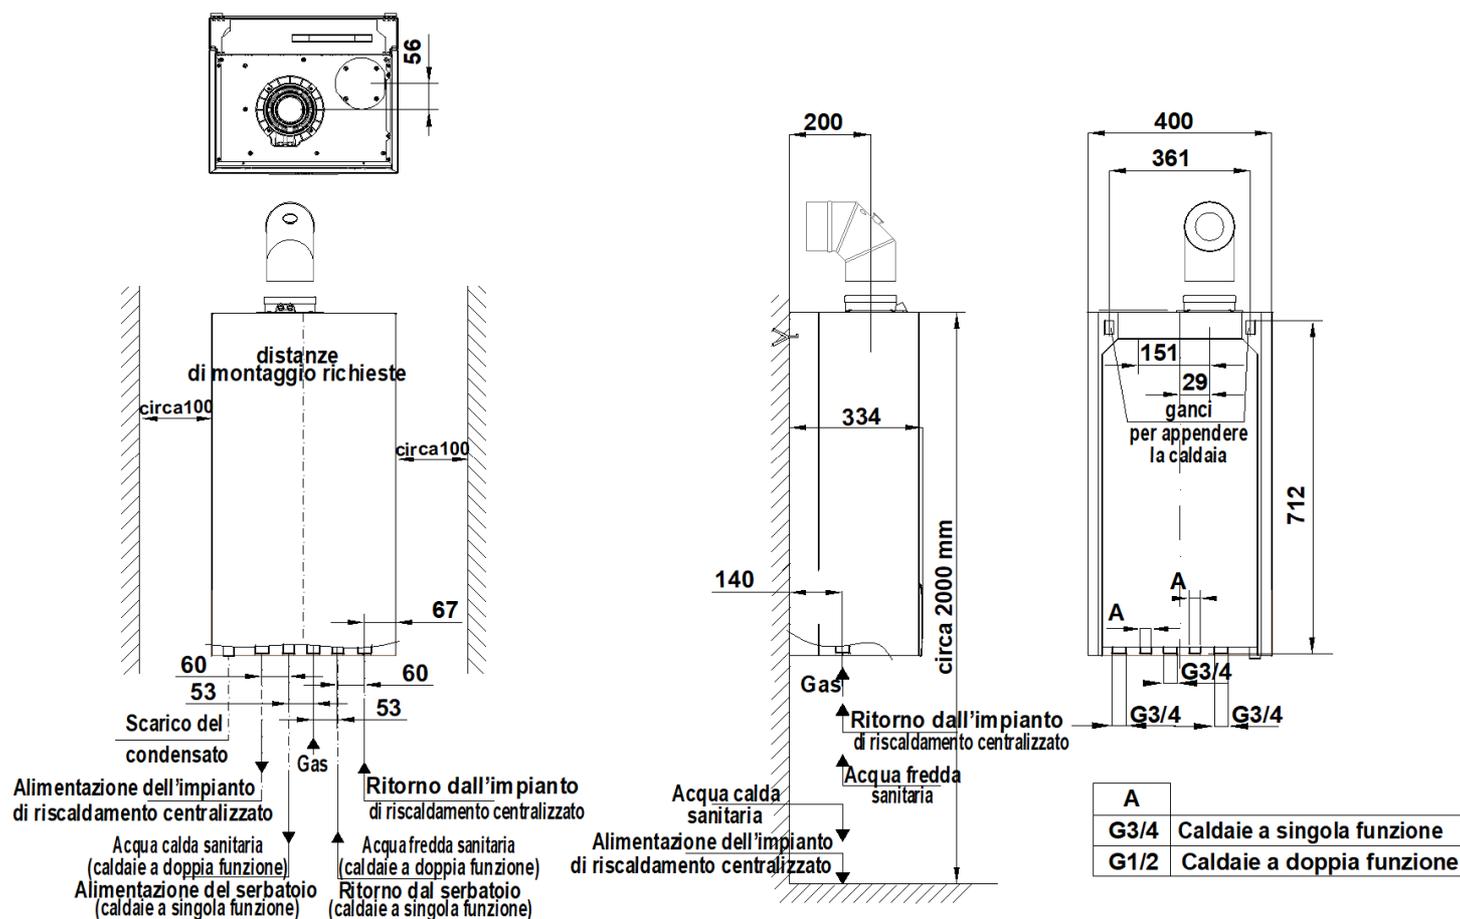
Requisiti d'installazione delle caldaie
